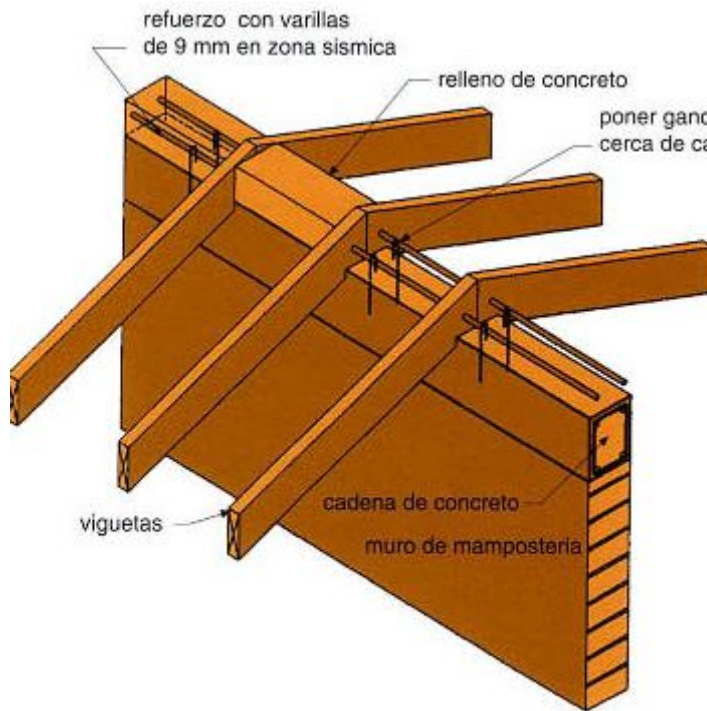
Fijación de Viguetas en cumbreras sobre Muro de Mampostería
